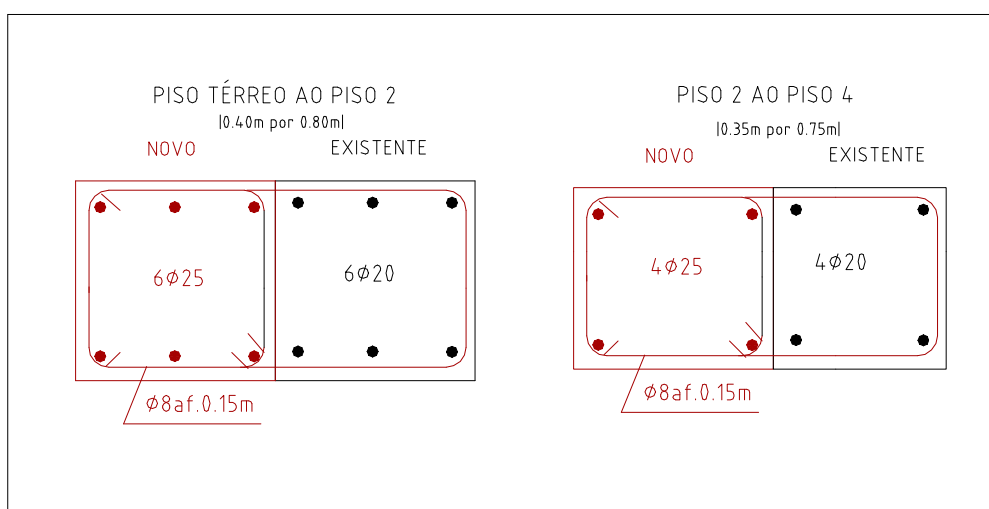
Pormenorização da solução de reforço por encamisamento dos pilares com betão.
